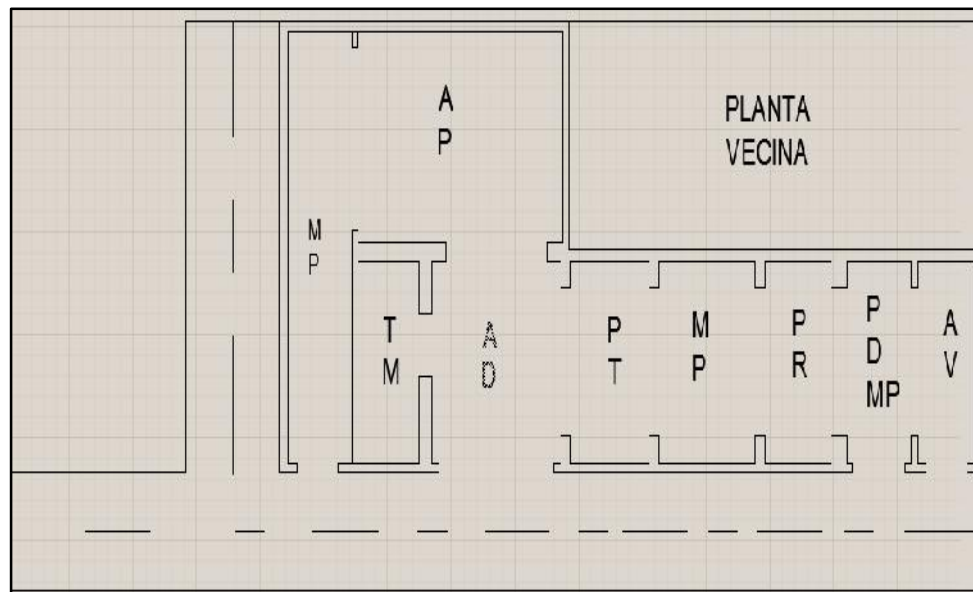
DISTRIBUCIÓN DE ÁREAS EN LA PLANTA
